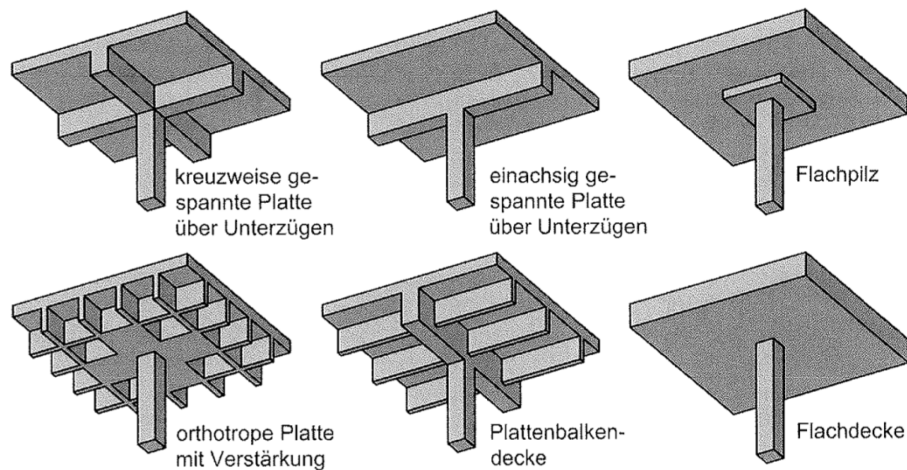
Tragstrukturen von punktförmig gelagerten Decken (Pech, Kolbitsch & Zach, Baukonstruktionen – Decken, 2006, S. 23)
